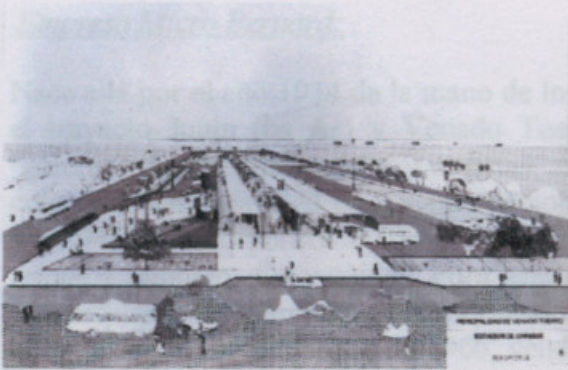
Imagen I: Fachada de la Estación de Calle Quintana, en su etapa de proyecto.
